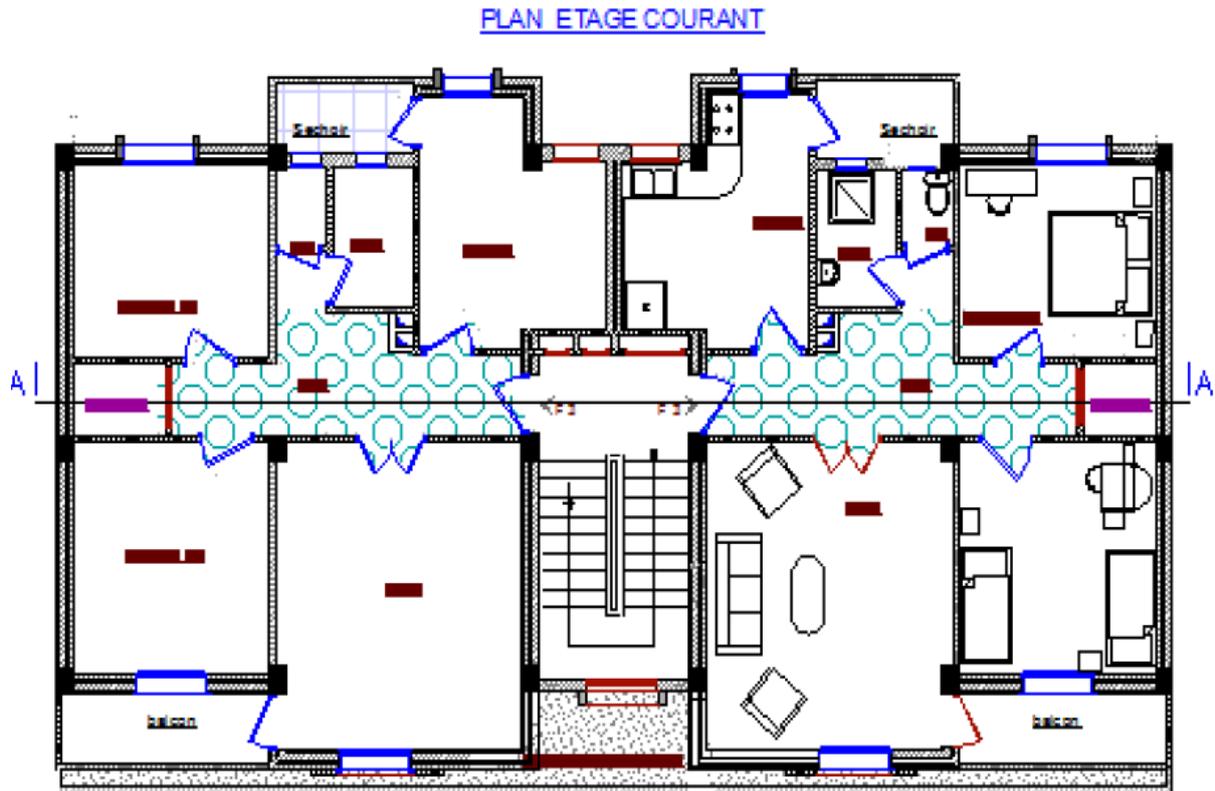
Vue en plan d'un étage courant du bâtiment
